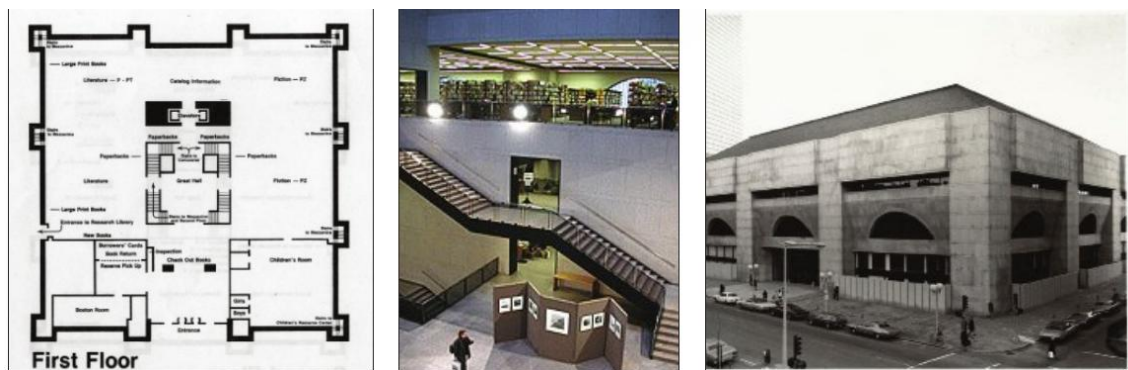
Planta da Biblioteca Pública de Boston
